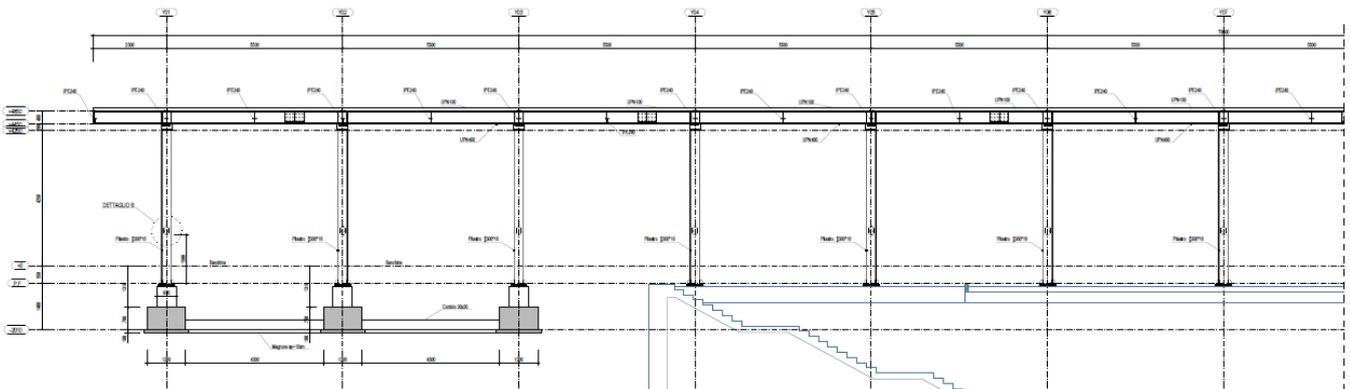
Pensiline – Stralcio sezione longitudinale - Pensilina Sud
